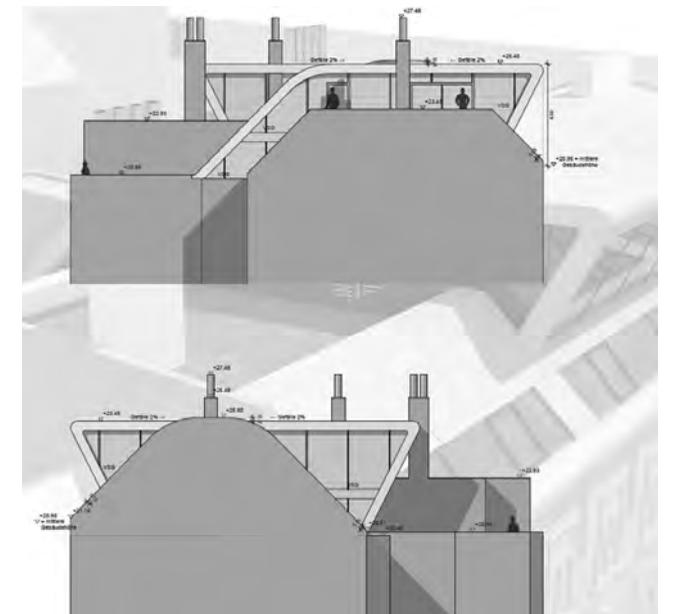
Ansicht eines Entwurfes (SS2014, Dachgeschossausbau; Studierende: M.Koliha / G.Pfister); Grafik: Entwerfen Rising*8 – M.Koliha, G.Pfister
